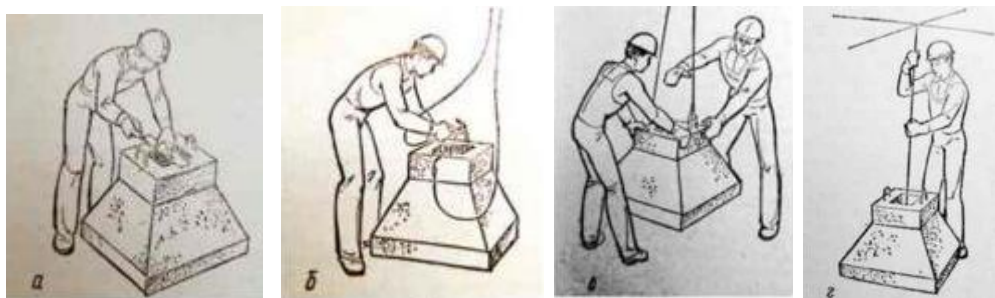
Послідовність монтажу стаканного фундаменту
